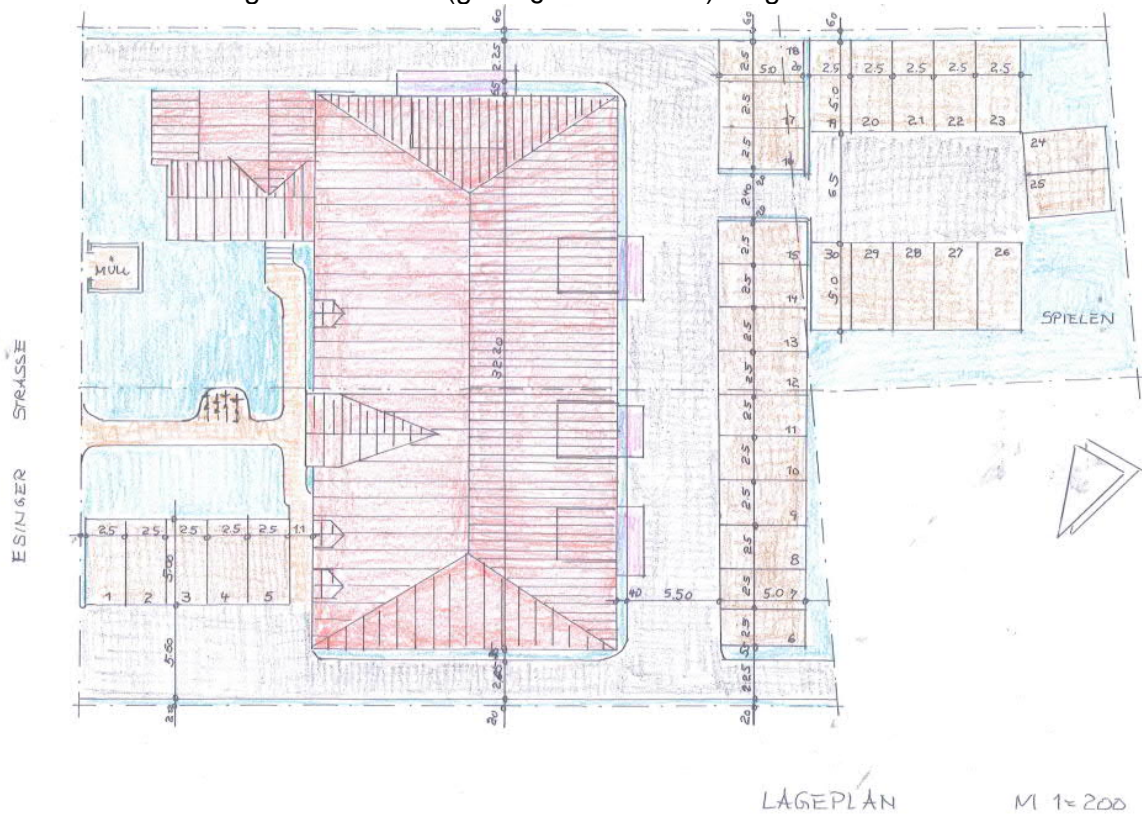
vorläufige Planung für das Mischgebiet - Lageplan [4]
